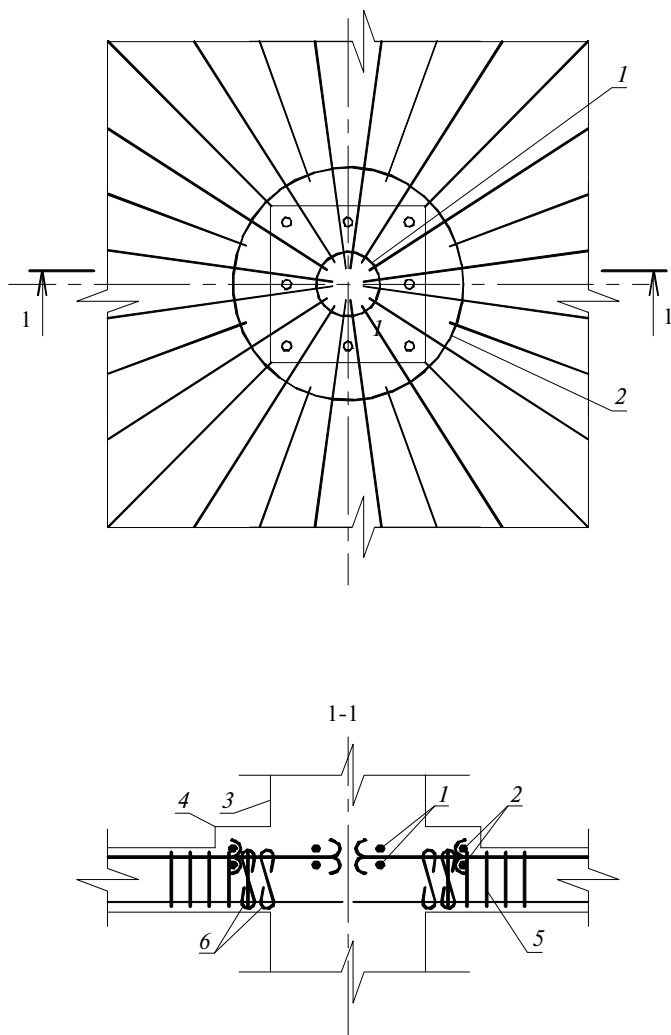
Стык арматуры перекрытия посредством центральных и периферийных анкерных колец: 1 и 2 – центральные и периферийные анкерные кольца; 3 – колонна; 4 – местное утолщение плиты; 5 – поперечная арматура в составе сетки; 6 – шпилька
